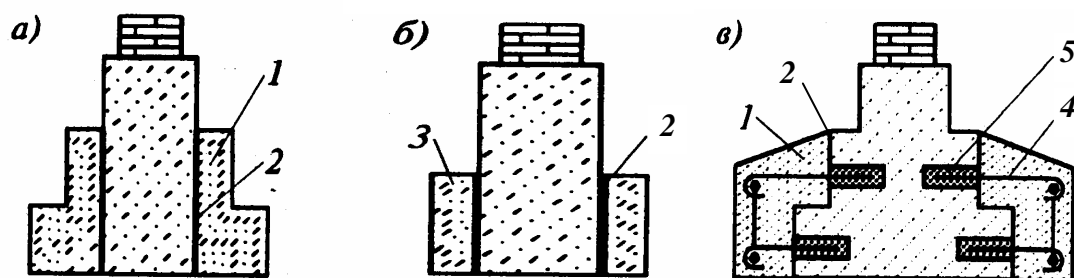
Усиление ленточных фундаментов из монолитного бетона:
